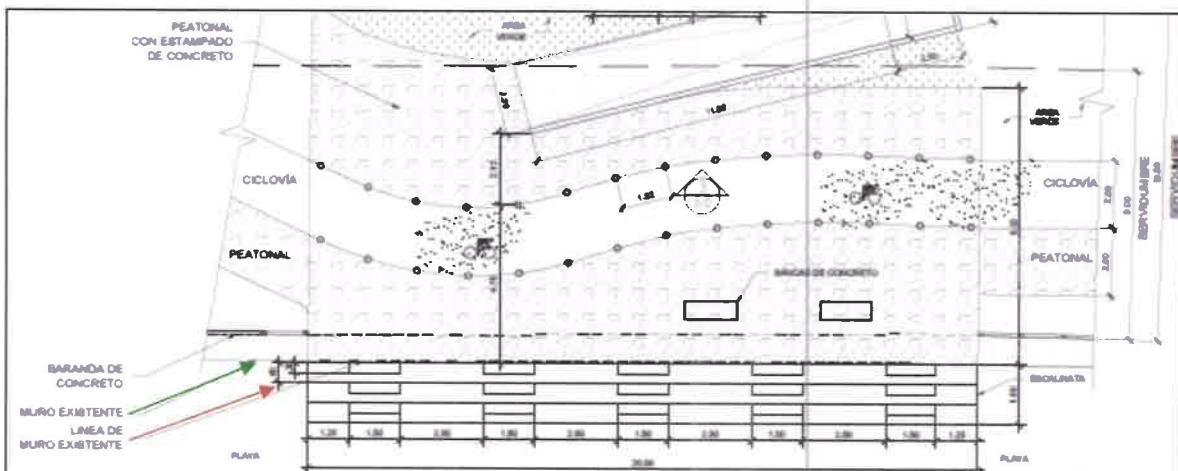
Plano de anteproyecto de plazoleta, se pueden observar, el muro existente (flecha verde) y la línea de muro existente (flecha roja) y hacia la playa las escalinatas.
